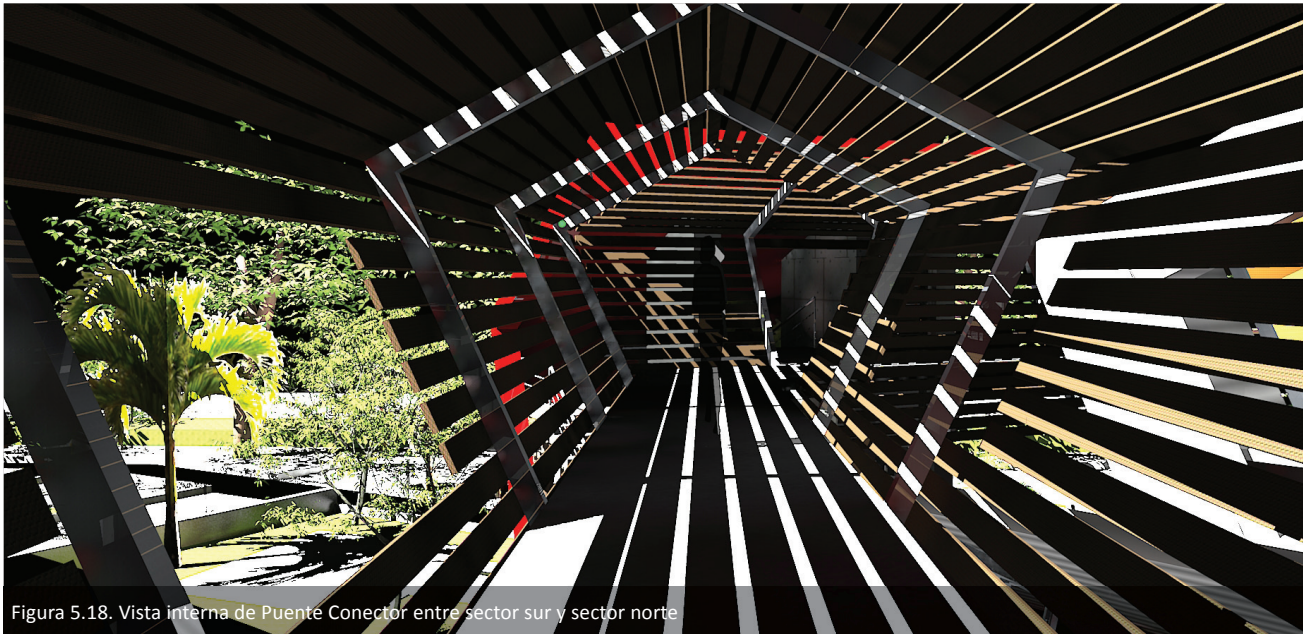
Vista interna de Puente Conector entre sector sur y sector norte
